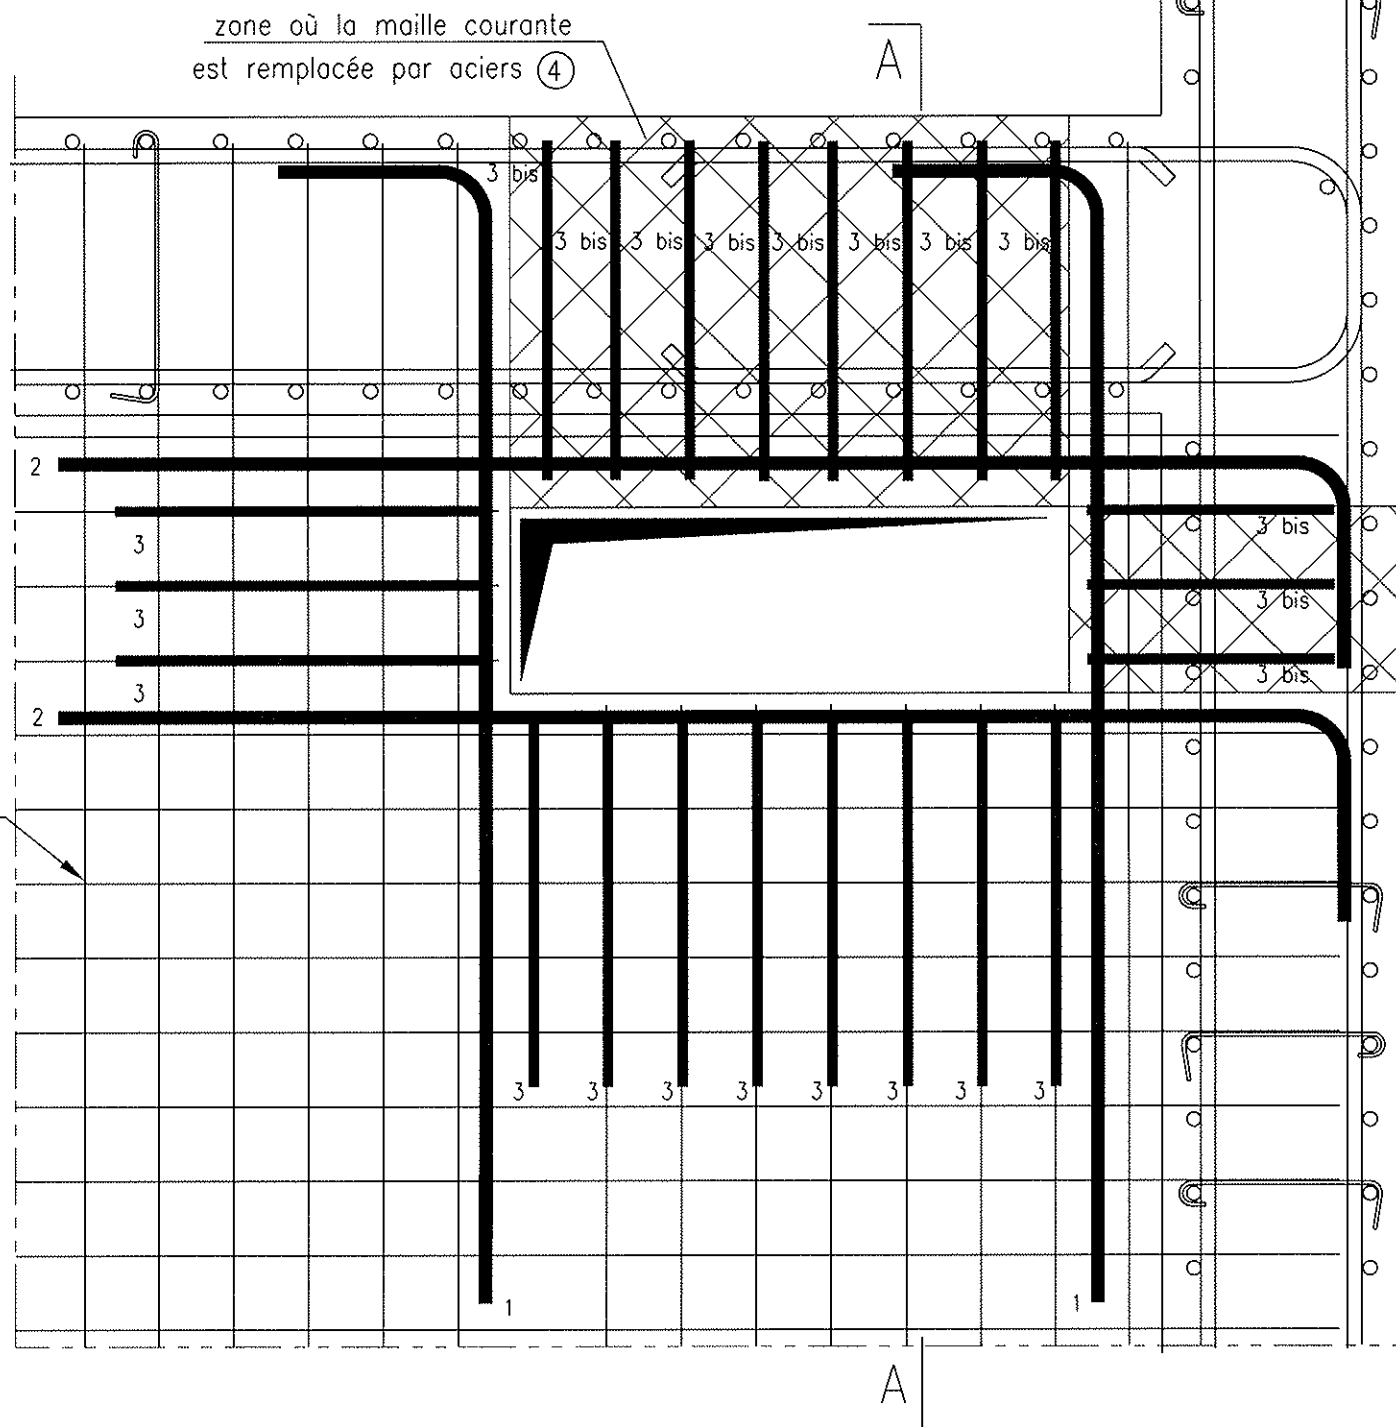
# DETAIL D'UNE TREMIE SIMPLE TRES PROCHE D'UN VOILE OU D'UN PLANCHER
